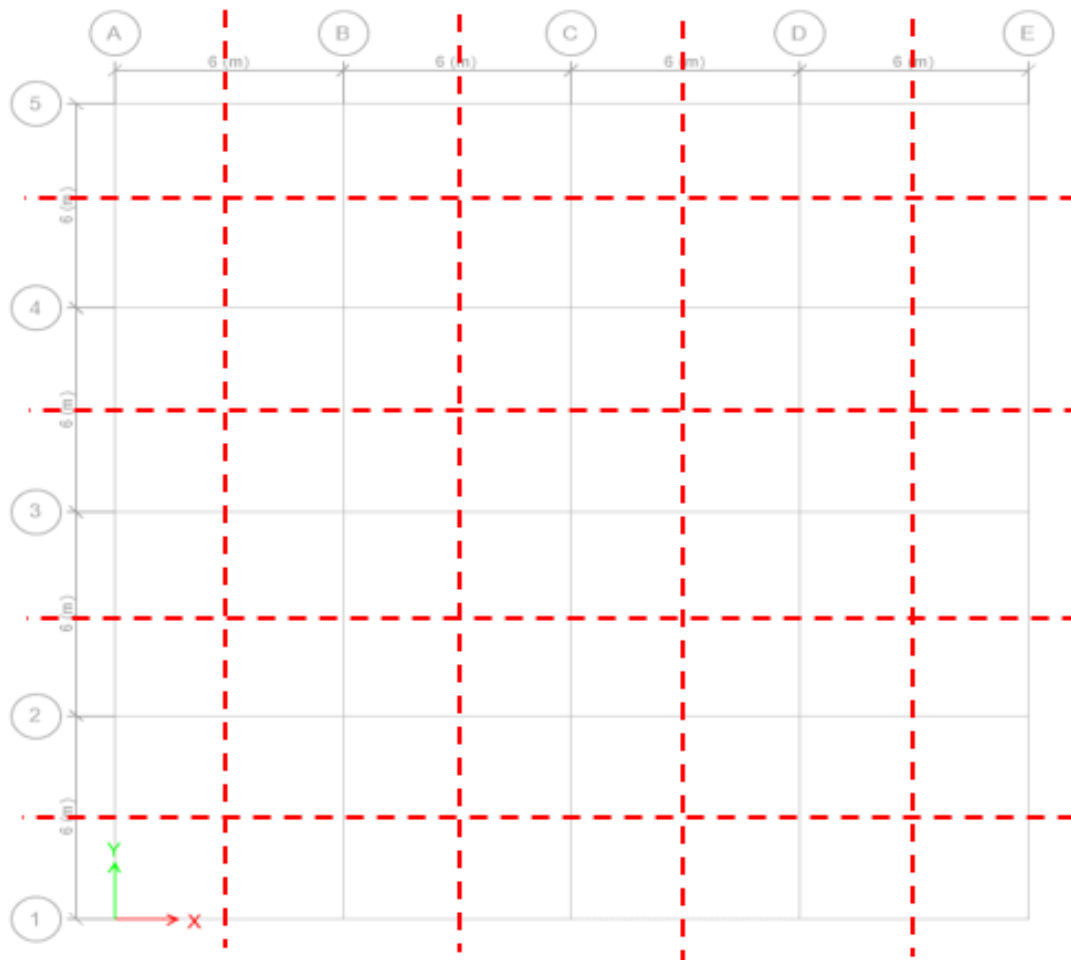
Edificación en base fija Vista en Planta Localización ejes estructurales. Fuente: Propia.
